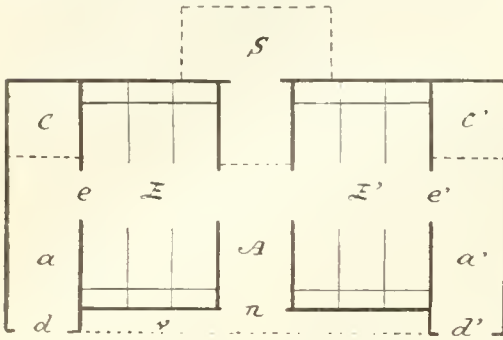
Plan d'une autre écurie à deux rangs tête au mur.
